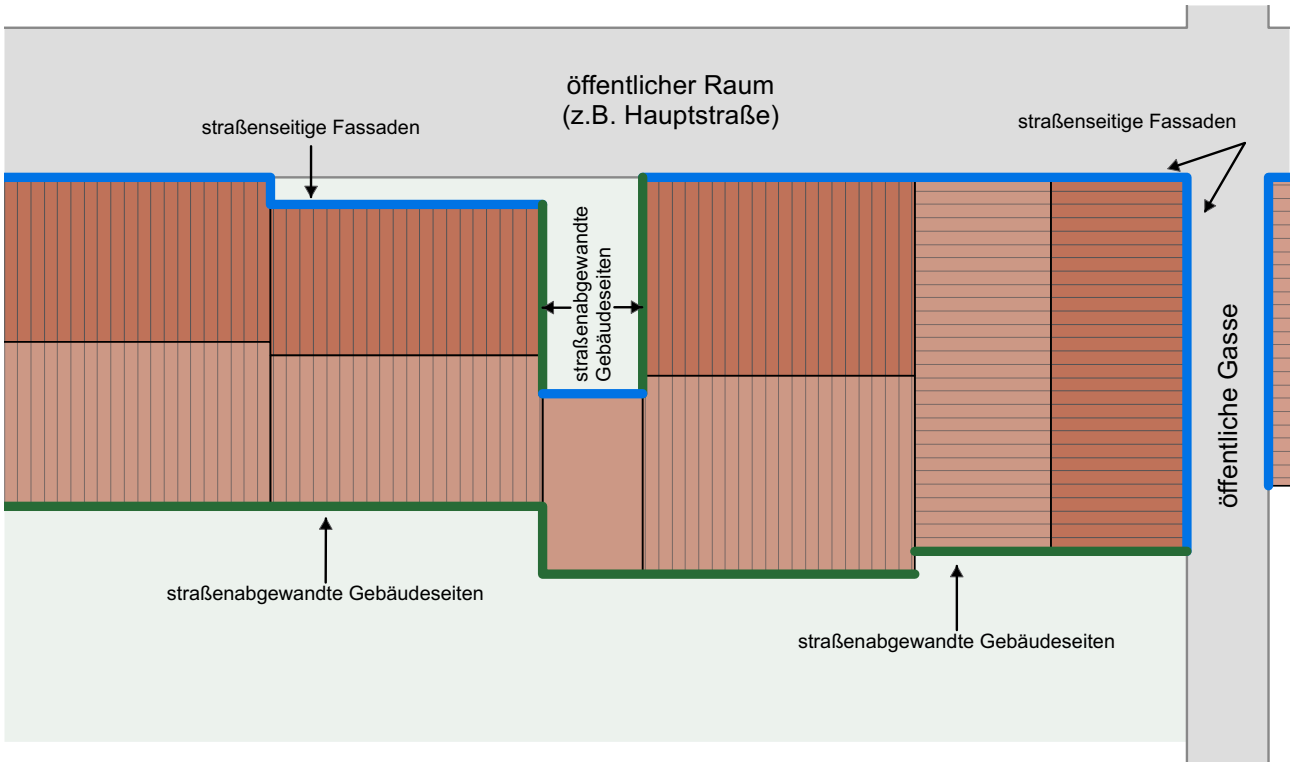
Erläuternde Skizze - straßenabgewandte Gebäudeseiten / Dachflächen
